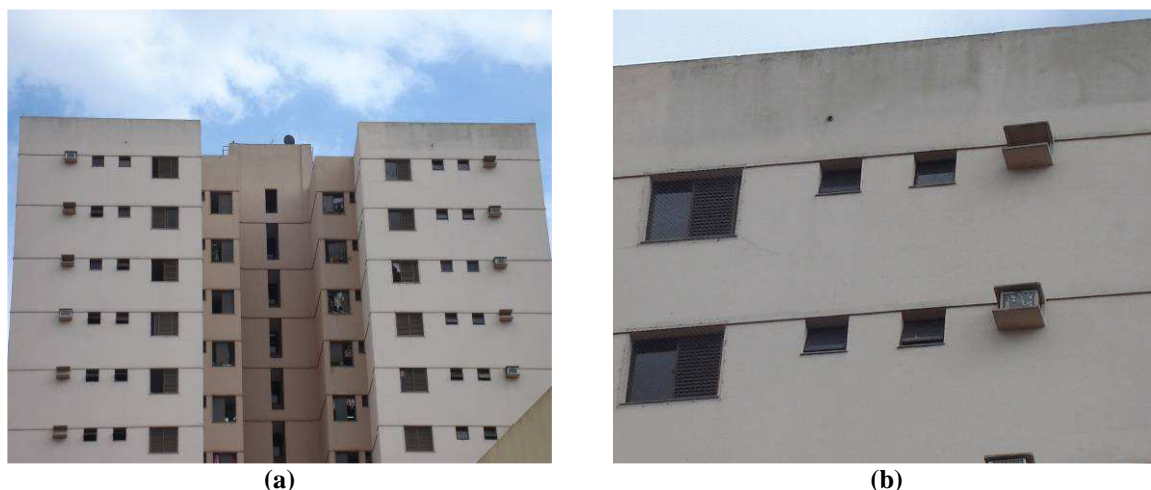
Vista geral de fachada com orientação S (a) e vista em detalhe da fachada com orientação S (b)
